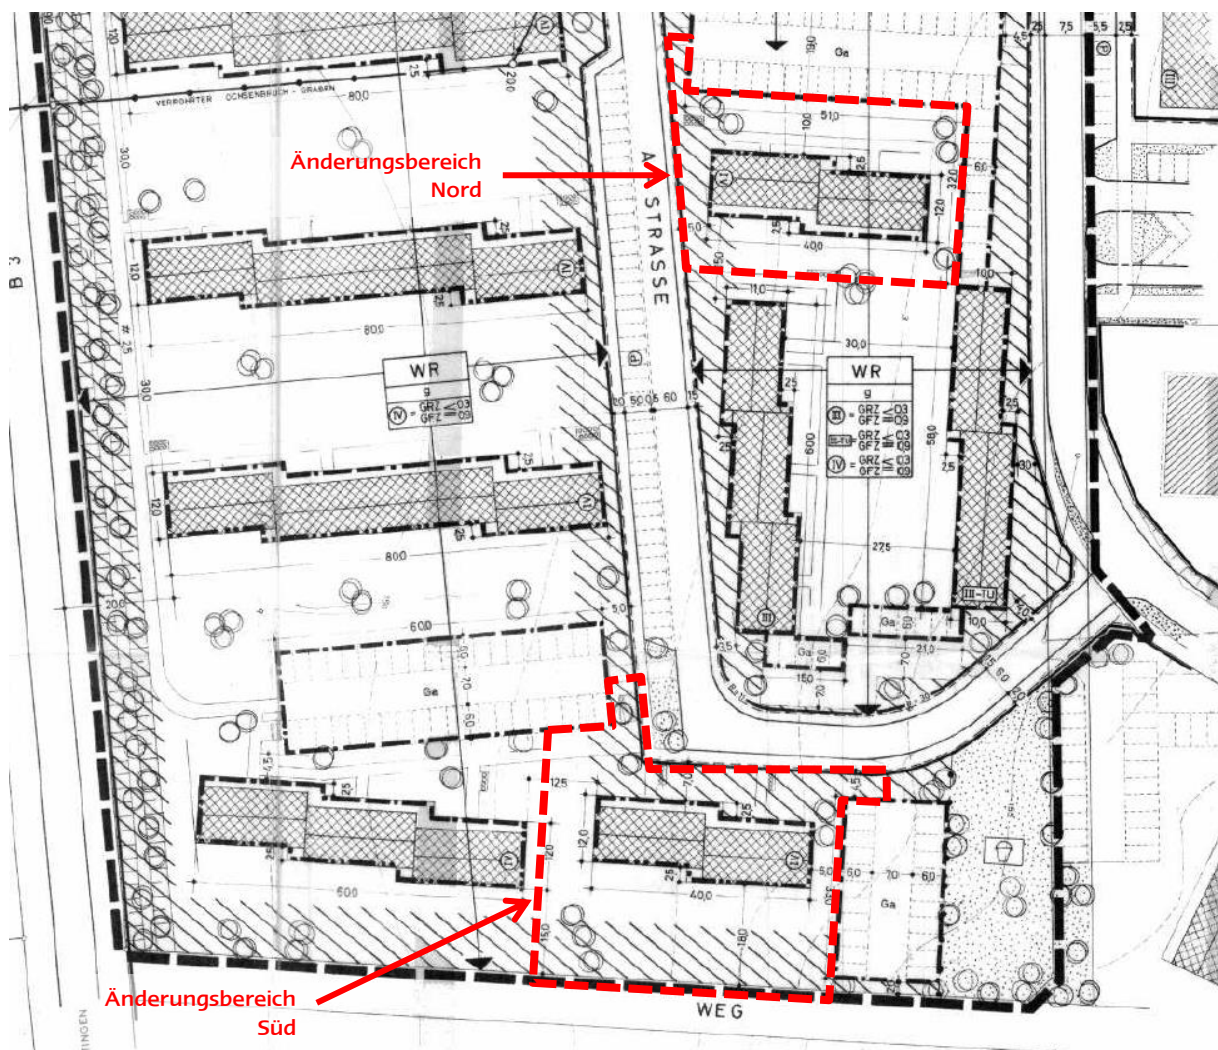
Ausschnitt der Planzeichnung des BP Nr. 6B „Vor dem Junkernberg“ und Lage der Änderungsbereiche der 2. Änderung
